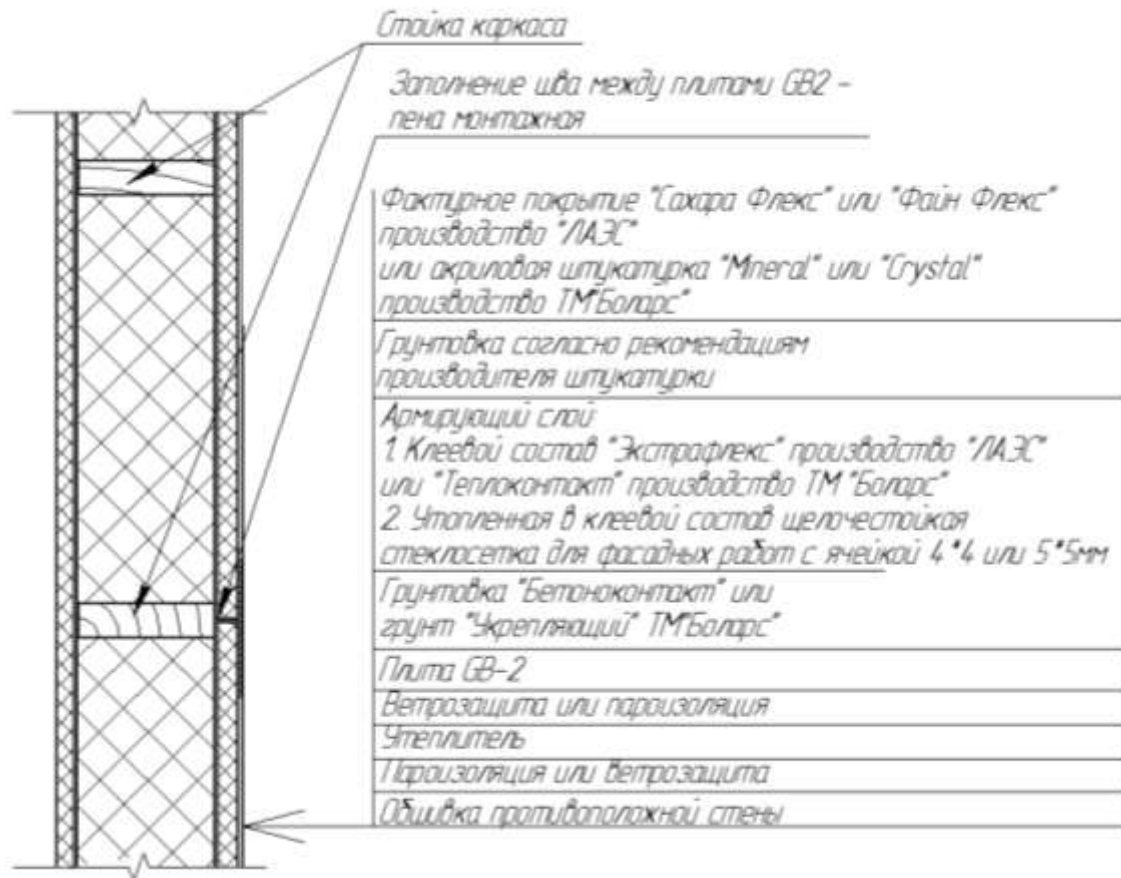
Конструкция стены без покрытия в разрезе. Вид сверху.
